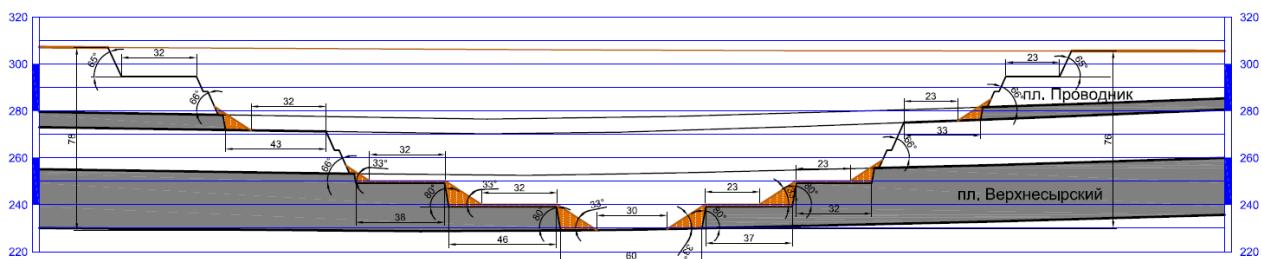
Поперечный разрез опережающей траншеи
